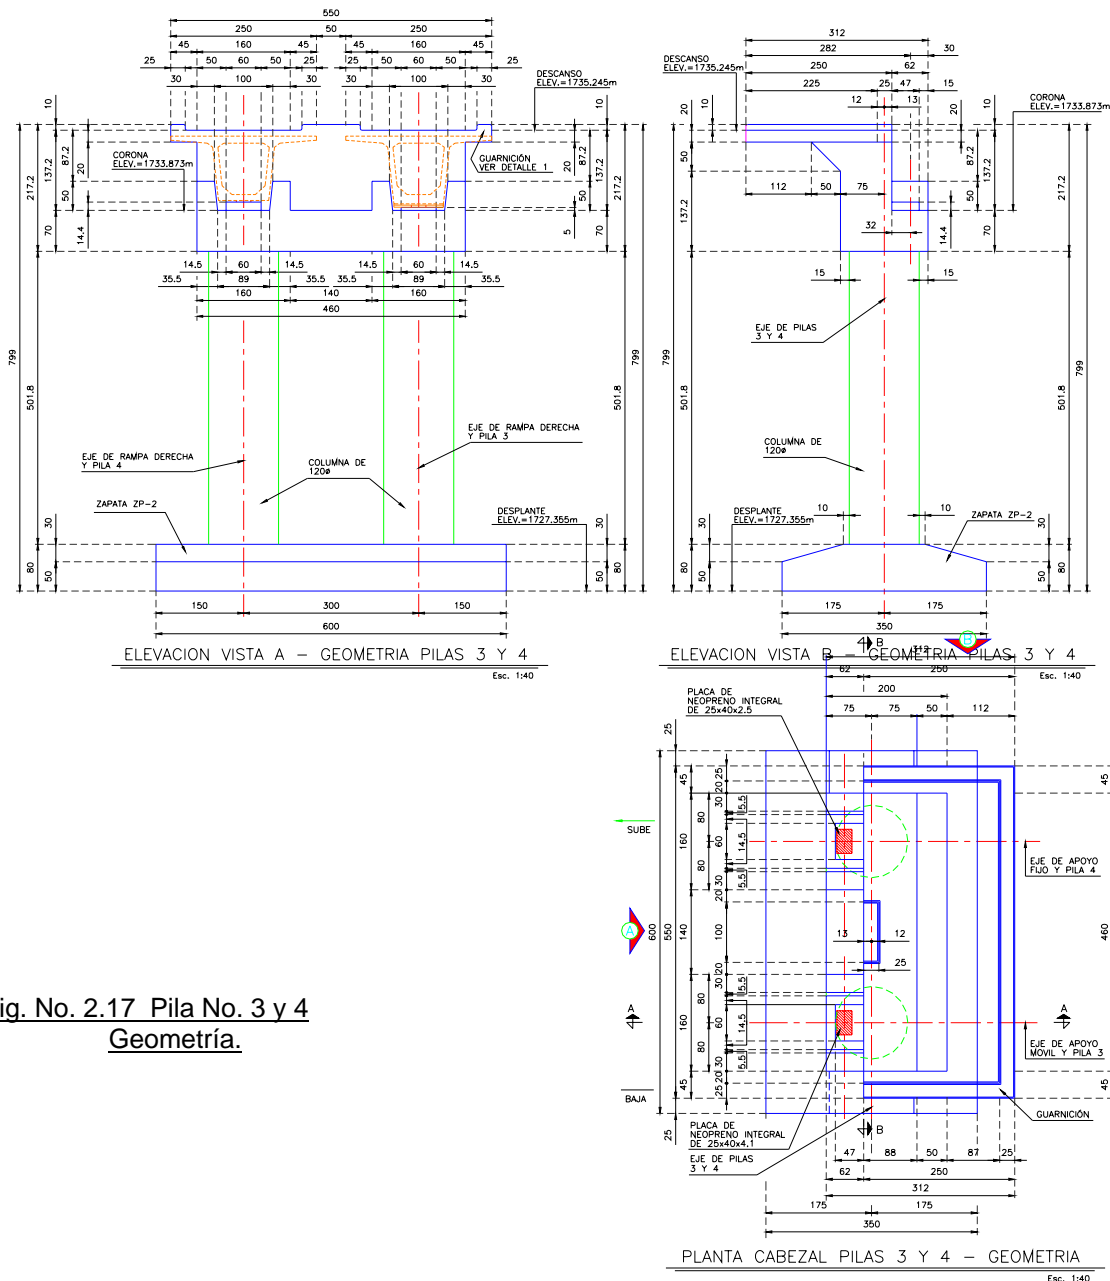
Pila No. 3 y 4 Geometría.
